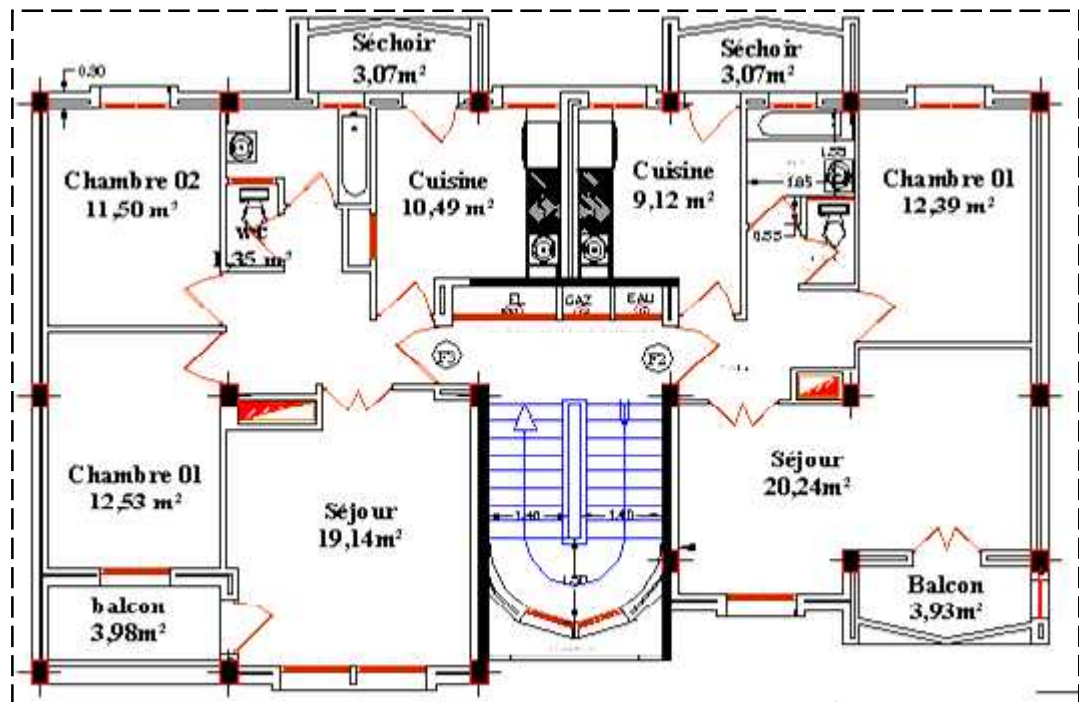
Plan RDC bâtiment barre du 2^{ème} cas d'étude 456 logements (source : bureau d'étude)
